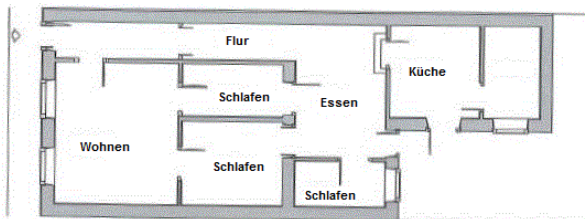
Grundriss eines Kolonialhauses „Casa de Porta e Janela“ [BROSS, 2002; S. 139]
